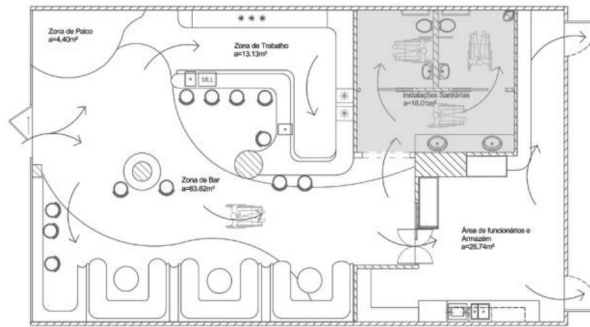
Identificação das Instalações Sanitárias em planta (Camila Schmidt, 2025)
